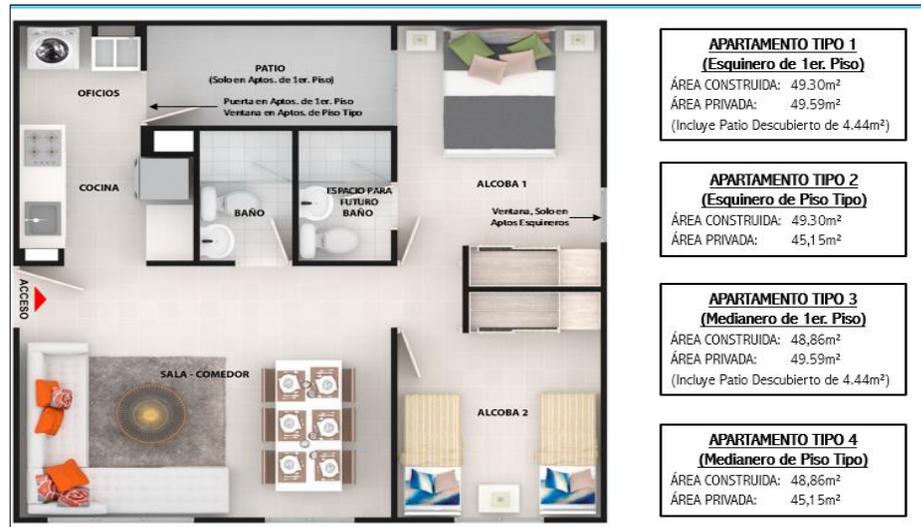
Distribución arquitectónica apartamento tipo 1-2-3-4
